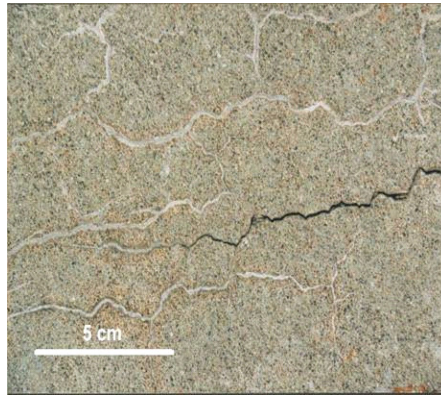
Stark gerissene* Betonoberfläche mit Ausblühungen (weiss) entlang geschlossenen Rissen und mit offenen Rissen (dunkel) >0.5 mm
